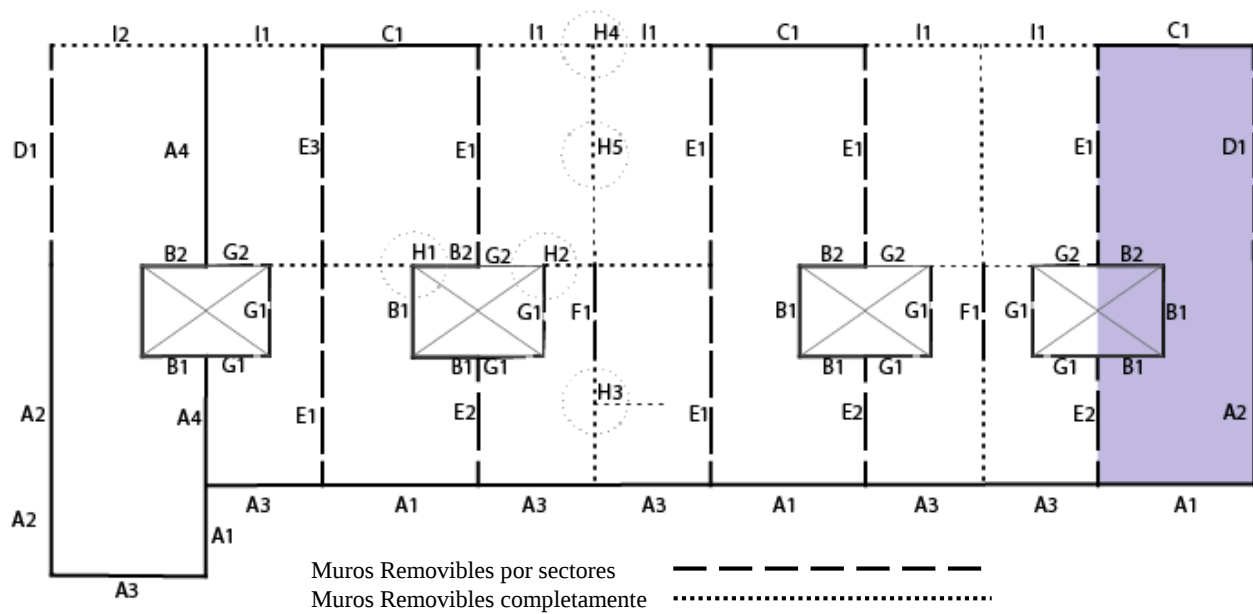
Posible ubicación de muros estructurales y no-estructurales. Team Metamorfosis.
